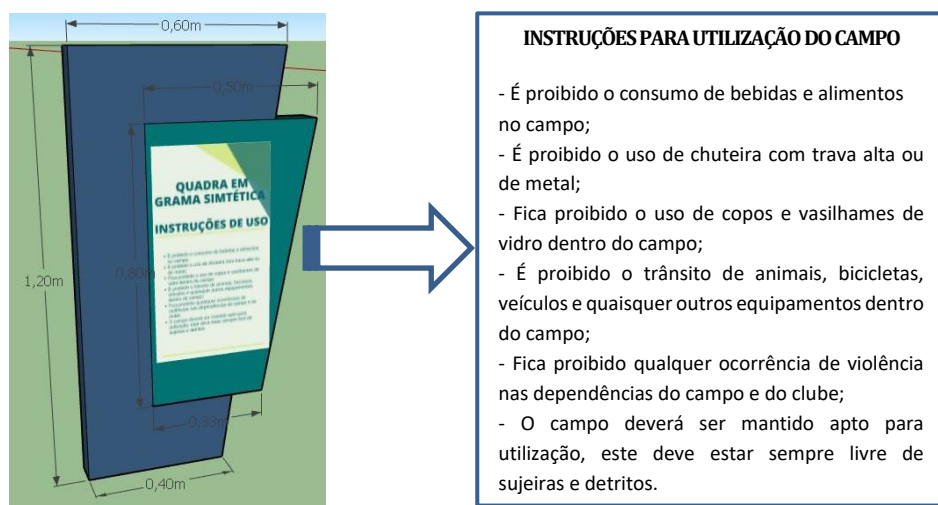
Detalhe Ilustrativo Placa de indicação de uso (Fonte: Autora/2021)
